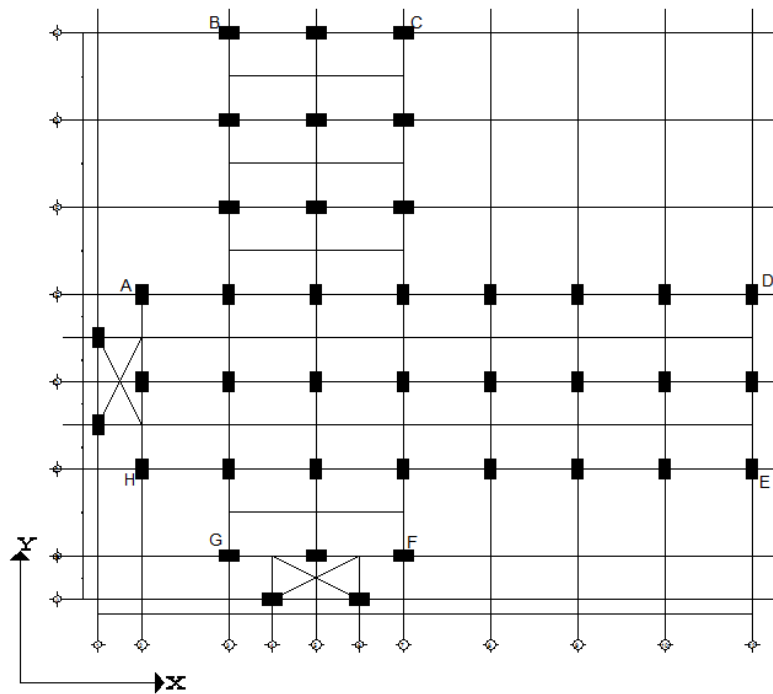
Denah Perletakan *Joint* yang Ditinjau Gedung Model 1
